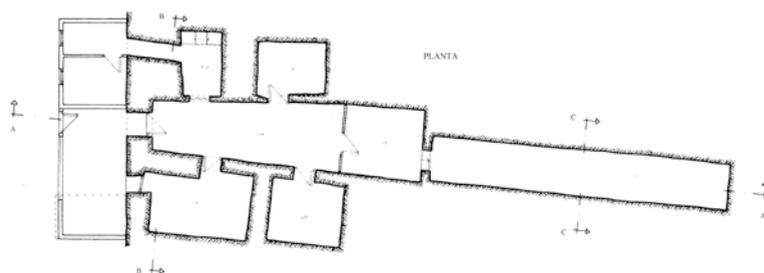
Plano de planta de una cueva dotada de la habitación “filaora”.
